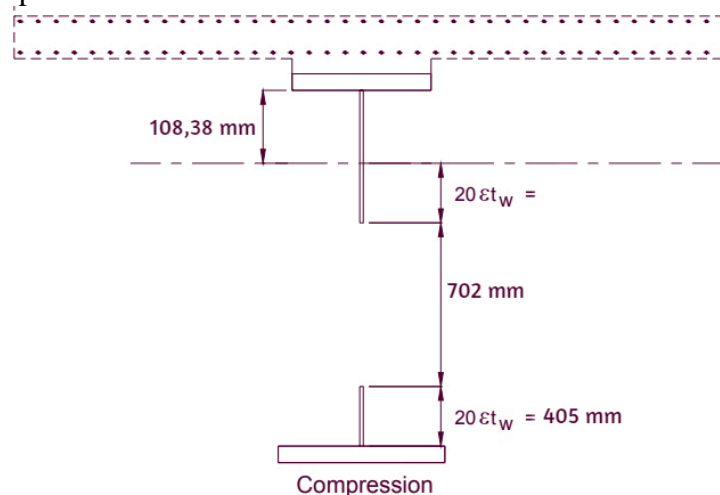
Reclassement en classe 2 efficace de la section sur (P1).
